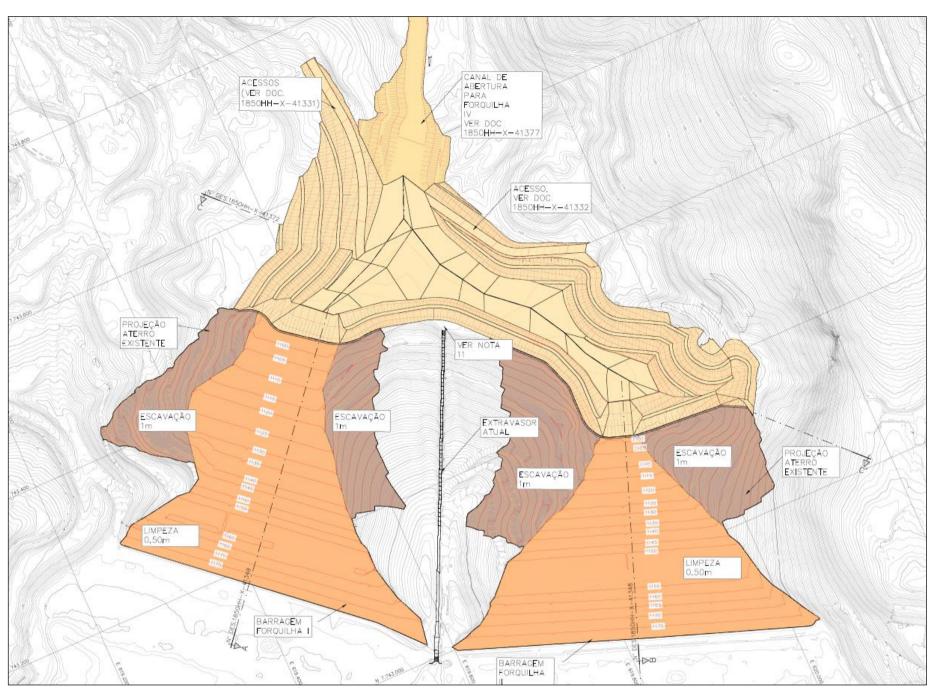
Tratamento de fundação - Planta. Fonte: 1850HH-X-41347
